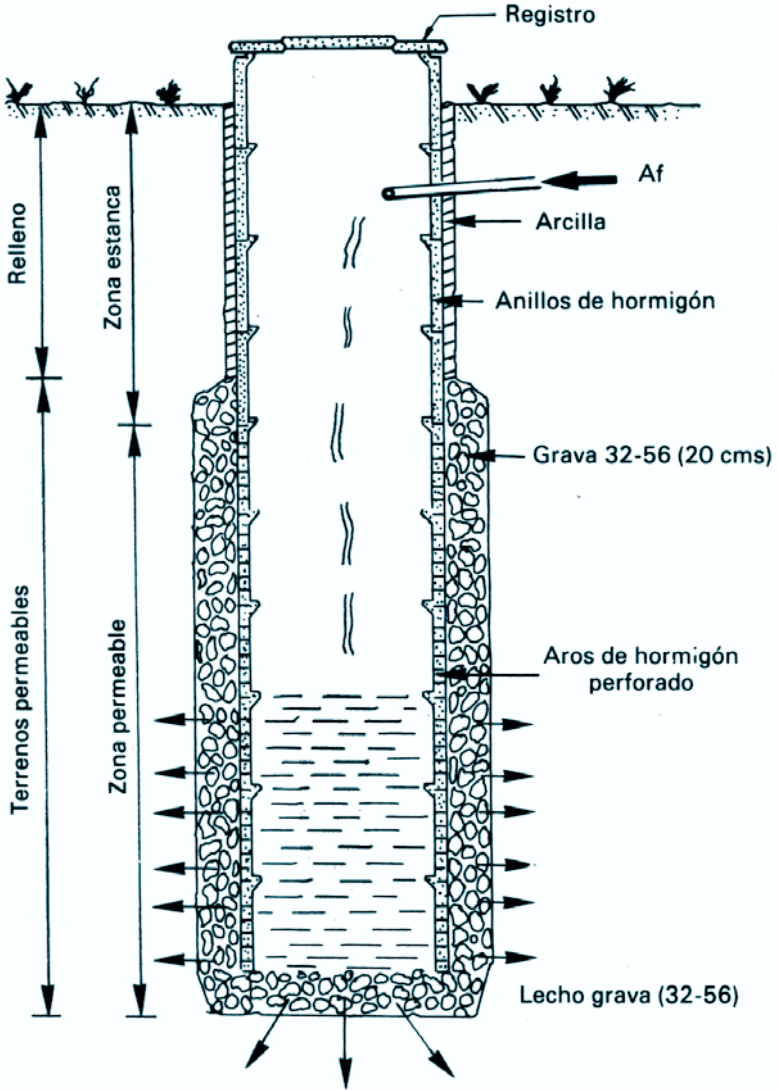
Características constructivas de un pozo filtrante (Rouhart, J., 1986)
